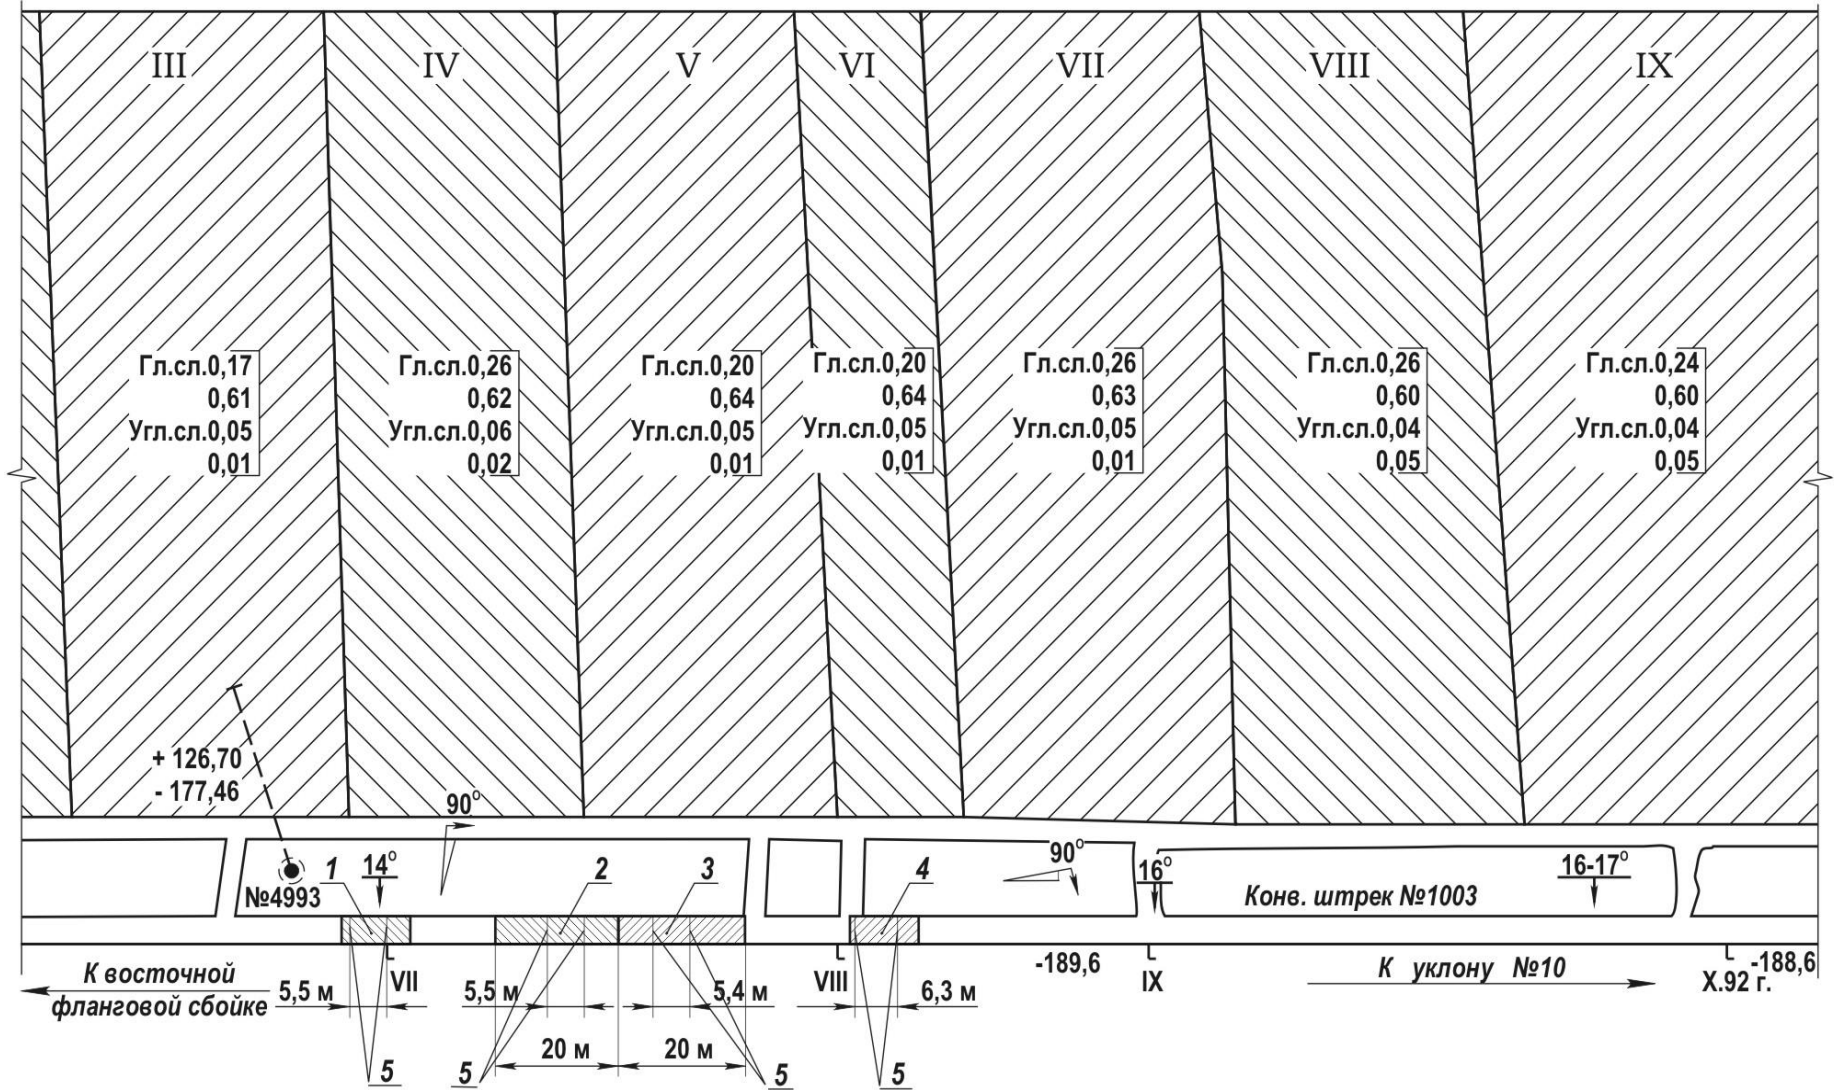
Выкопировка из плана горных работ по пласту K_2^H :
